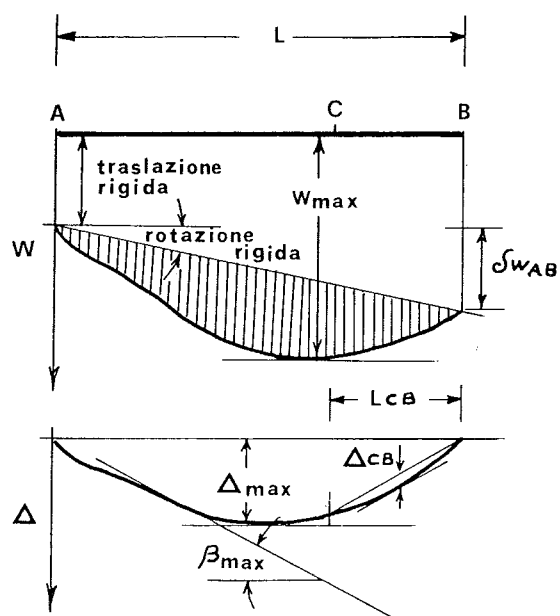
Definizione dei parametri caratterizzanti la deformata di un edificio.
